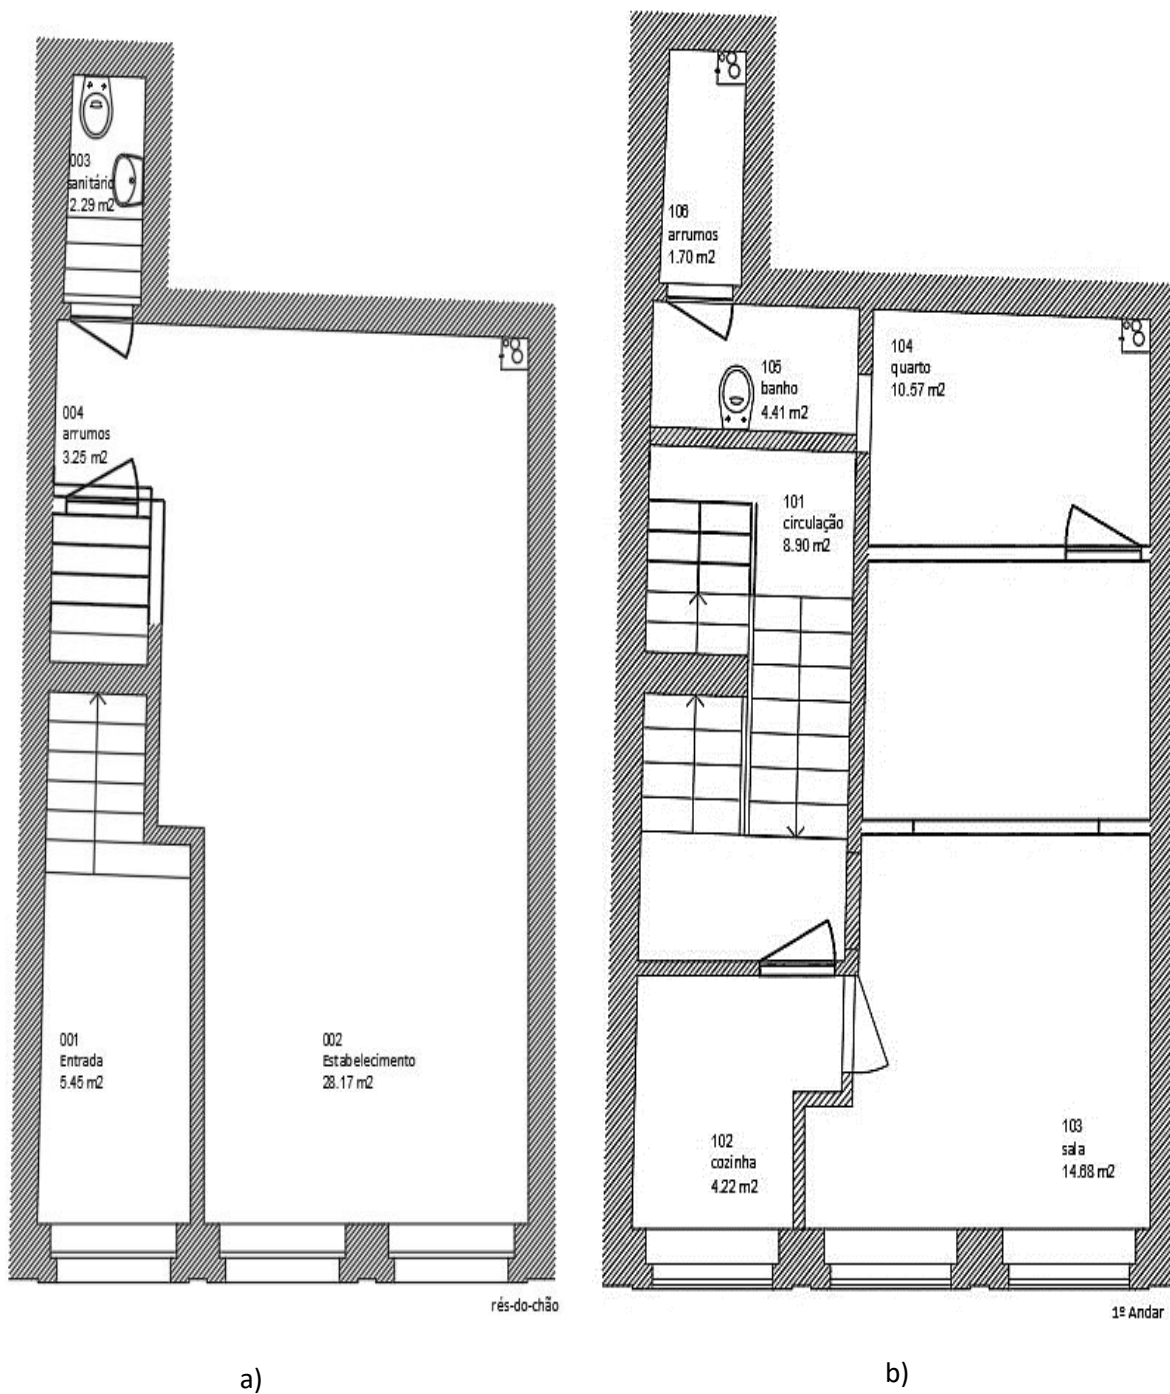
Plantas de arquitetura; a) Planta do rés-do-chão; b) Planta do 1º piso.
